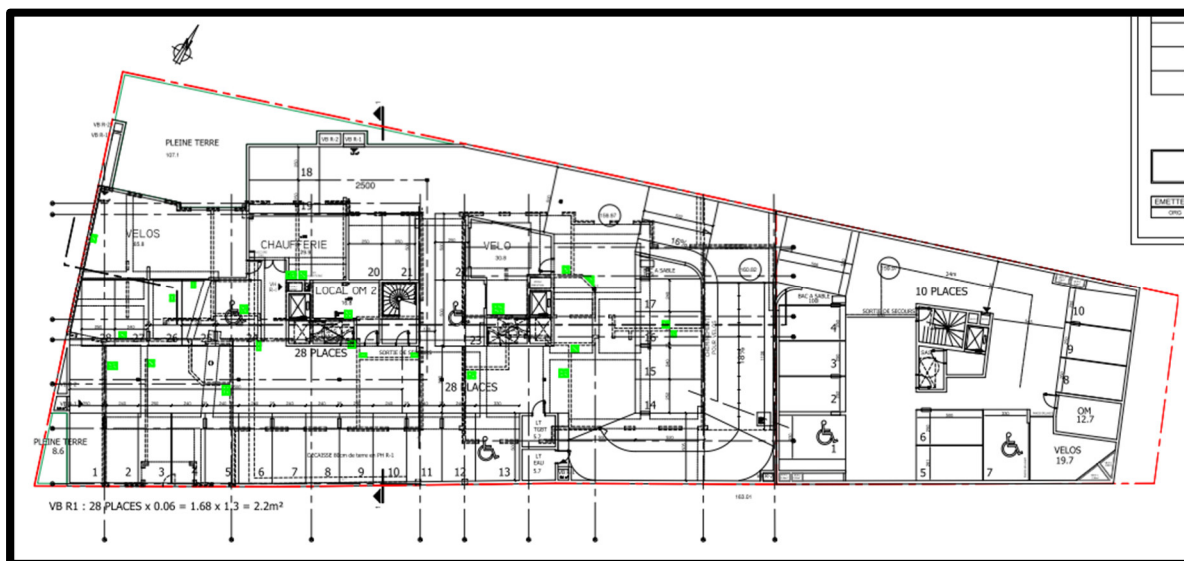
Planta Sub-Solo do edifício de estudo (fase projeto)
